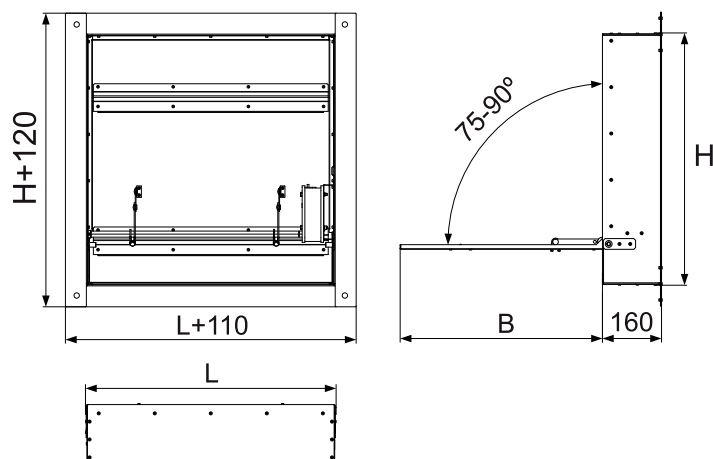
Габаритные размеры ДМУ с реверсивным приводом
